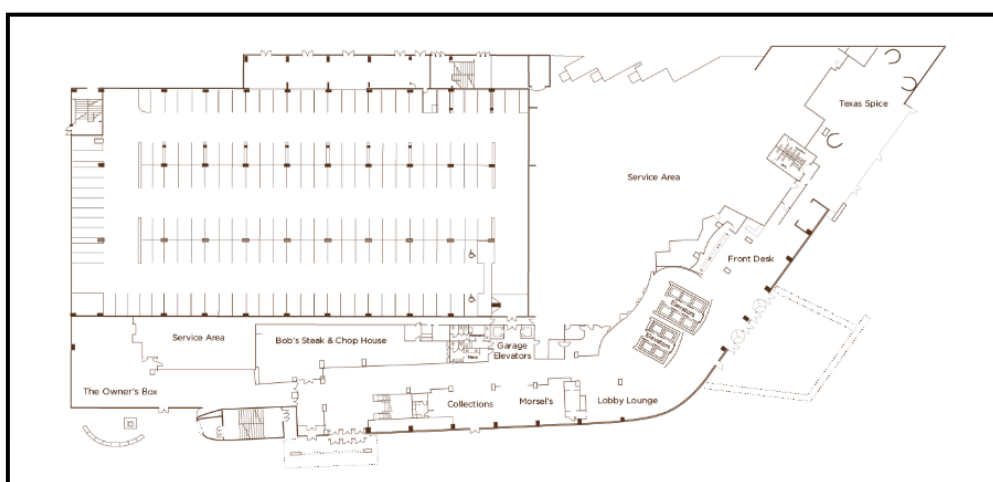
Plan du rez de chaussée Hôtel Omni Dallas
